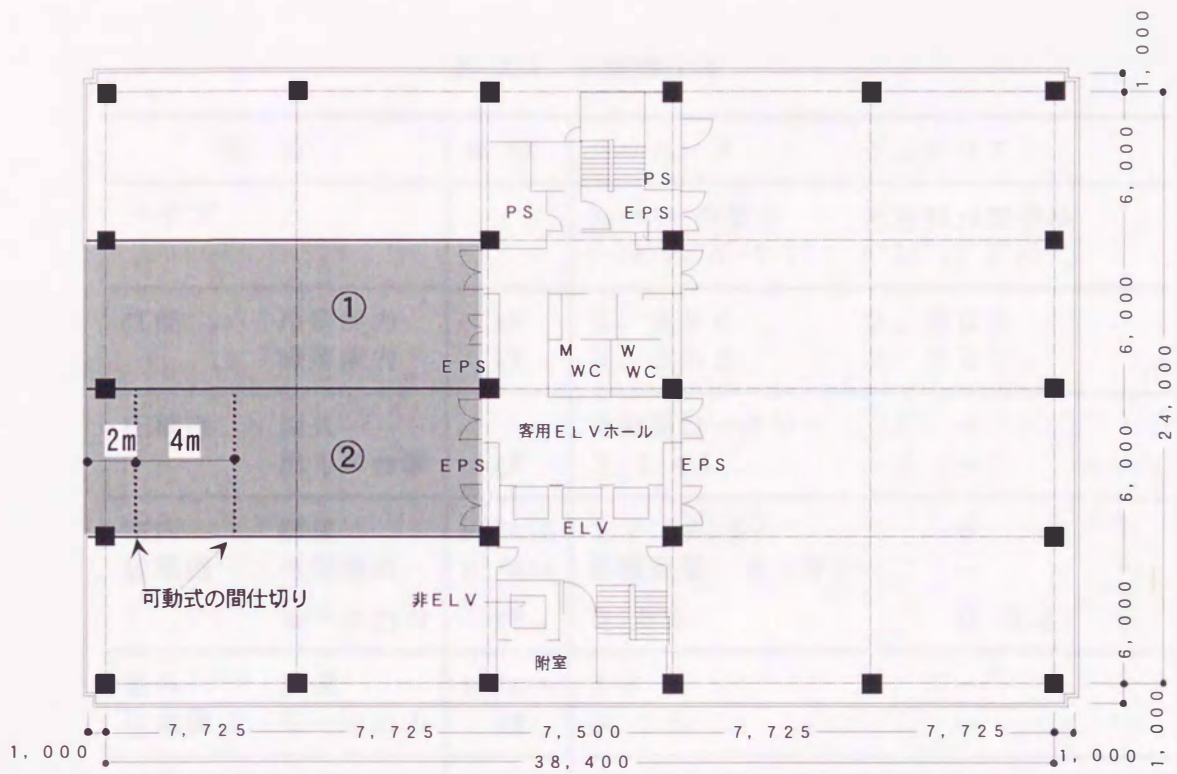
基準階平面図と実測対象ゾーン（単位はmm）
